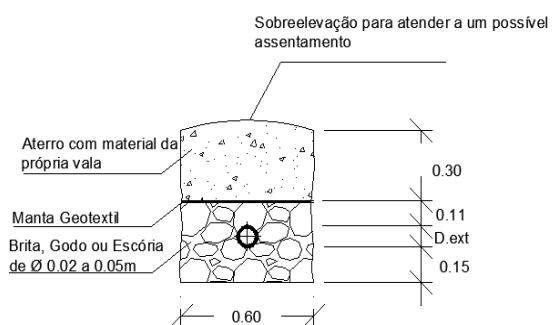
Corte de uma trincheira de infiltração, (adaptada de Bartolomeu, 1996).
